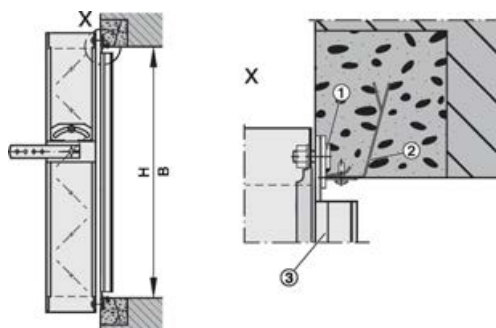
Installation murale avec contre-cadre (construction en aluminium)
